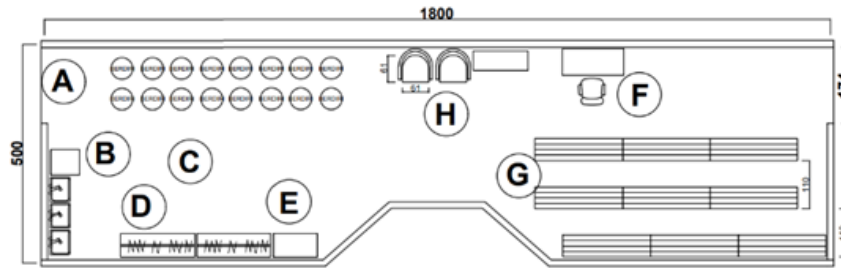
Layout Area Koor/Paduan Suara Gereja
